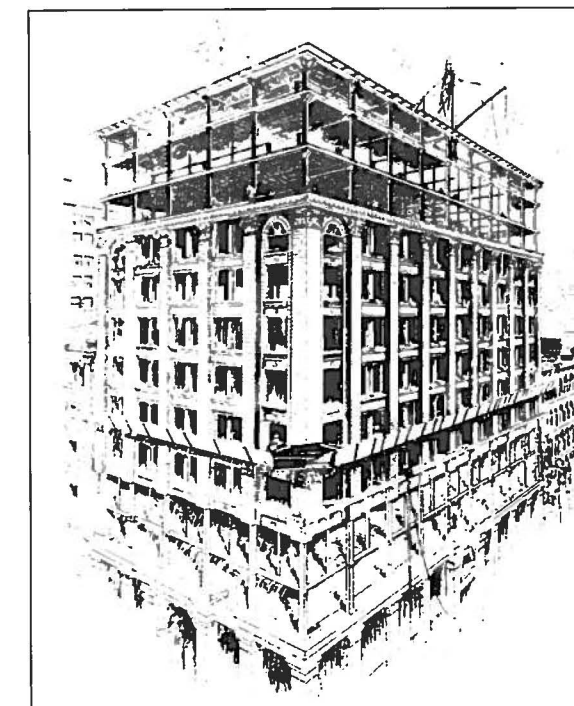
Le New York Life Building à Chicago (1892) illustre la cage construction qui a été construite en-dehors du mur-rideau en maçonnerie. Photo TDR.
